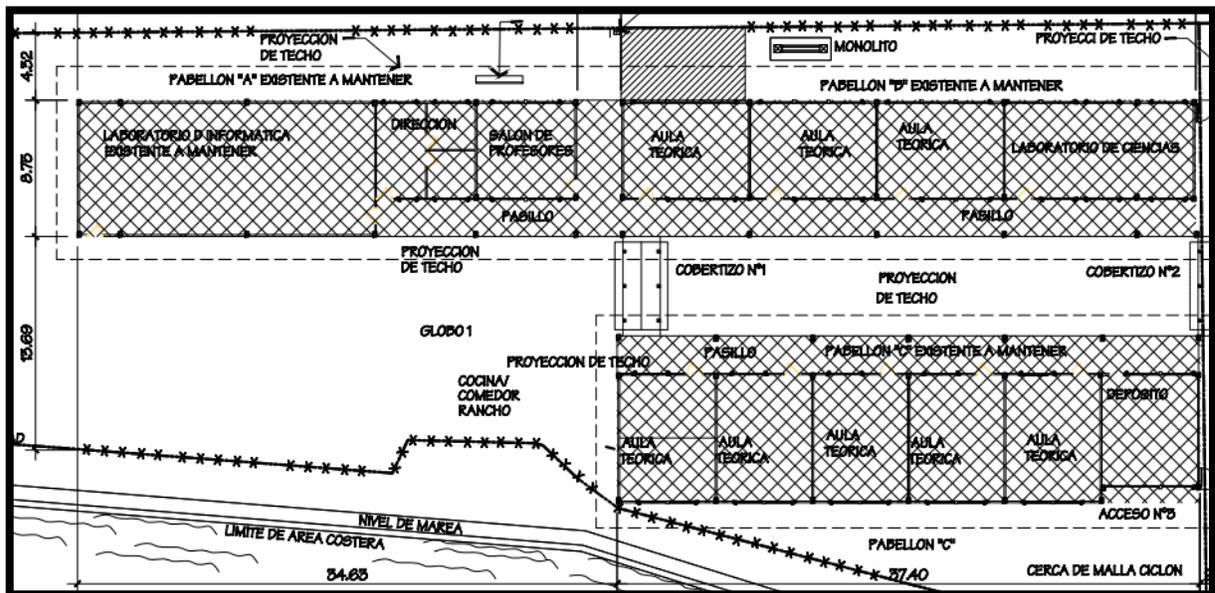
Detalle para la rehabilitación de la estructura existente.
